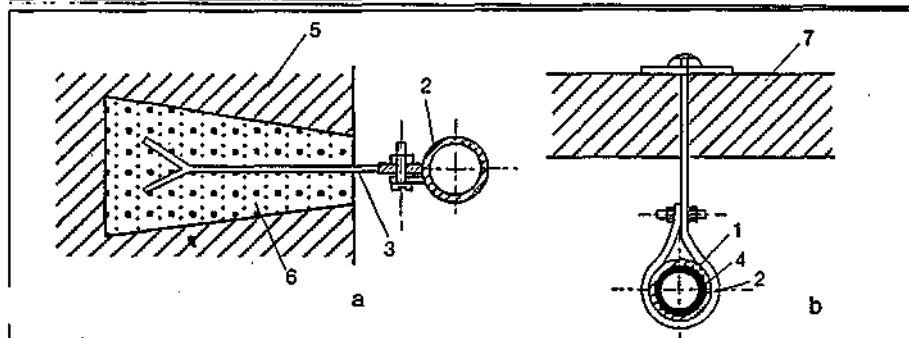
Brățări pentru susținerea conductelor verticale și a celor plasate la plafon:
